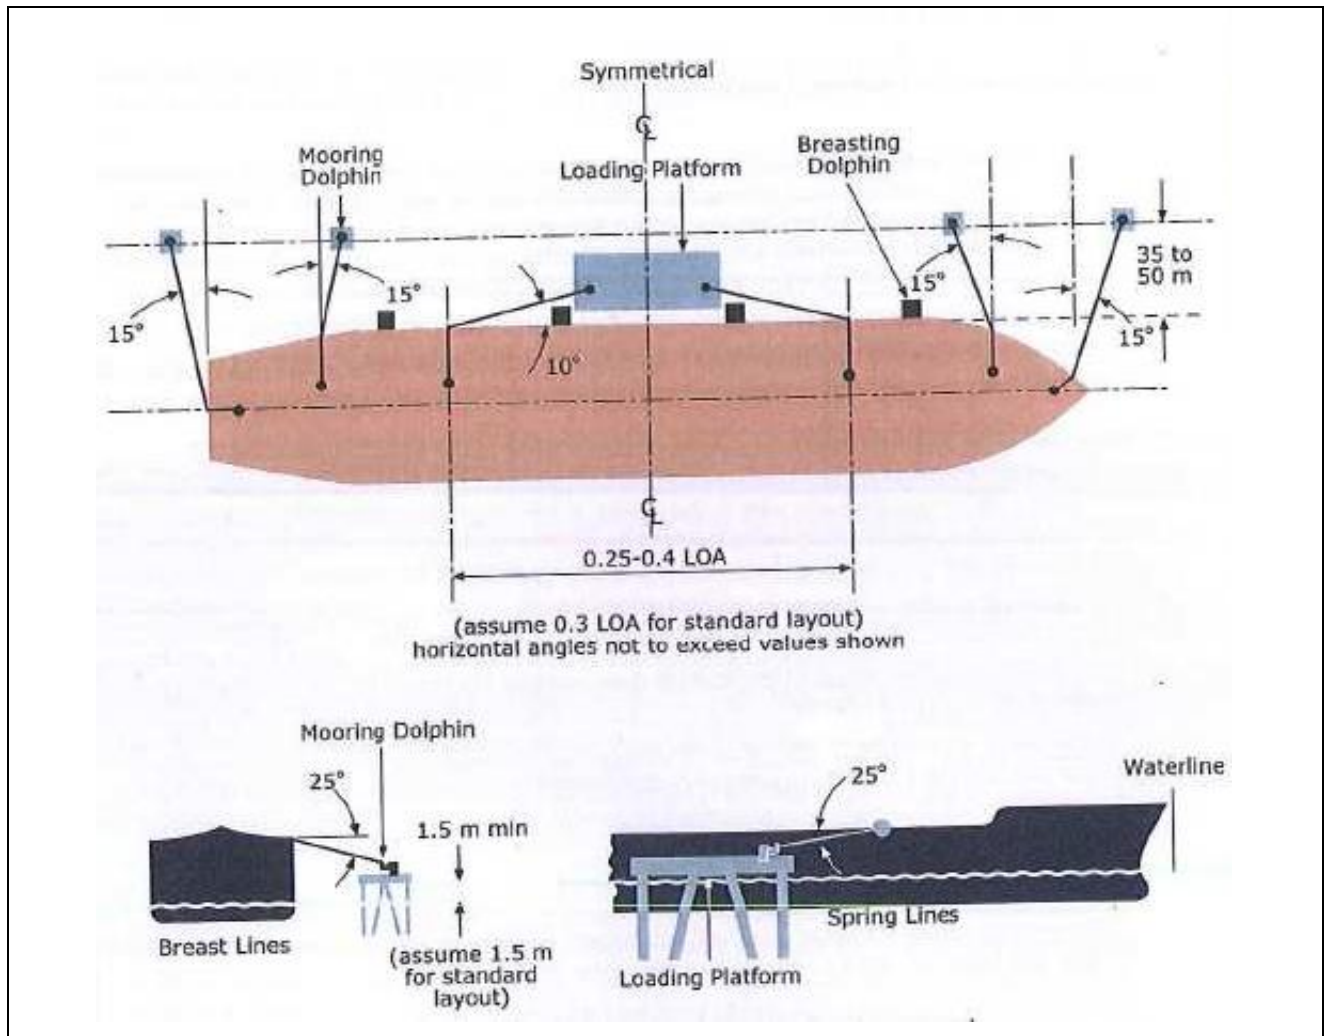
Layout ottimale sistema di ormeggio – Soluzione n°1
